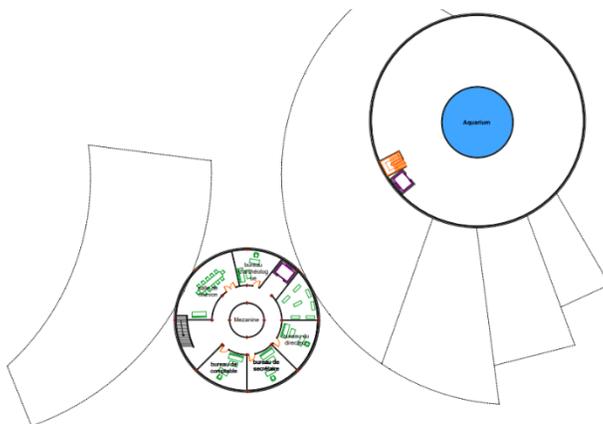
plan 2eme étage. (Source: auteur,2021)
